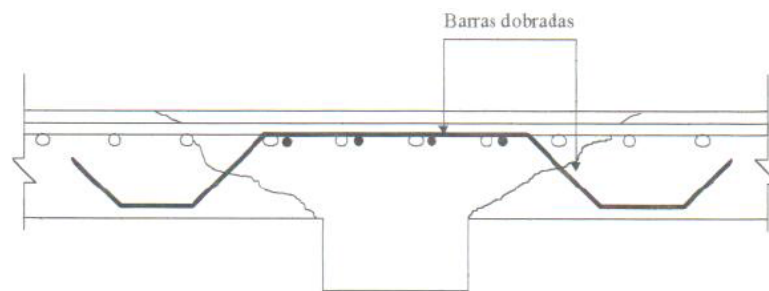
Armadura de cisalhamento utilizada por Hallgren
